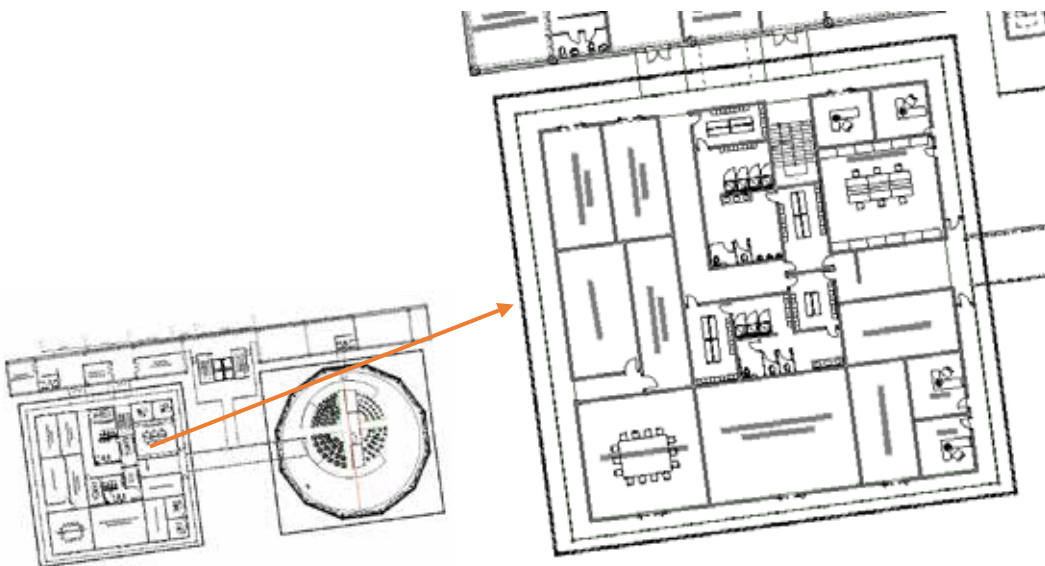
Planta 2 Nivel + 9.50 - Módulo 2. (2016)
